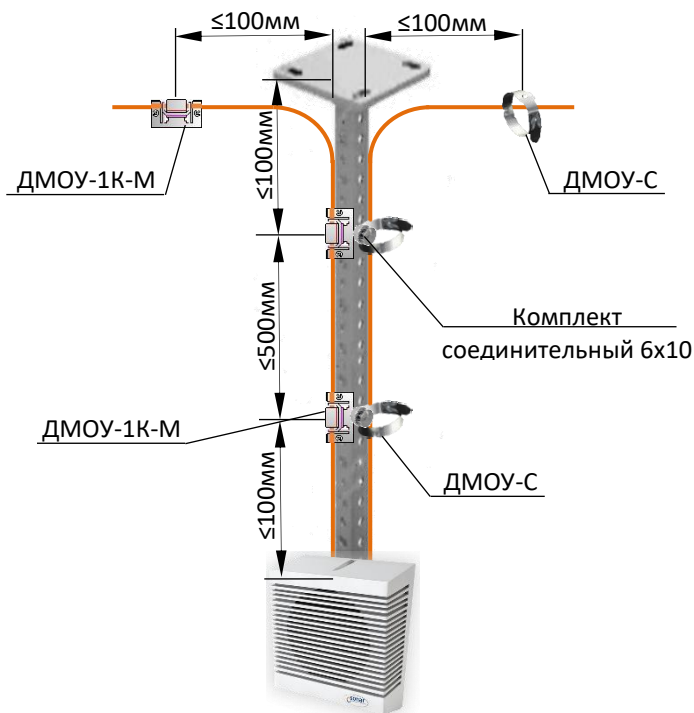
Спуск кабеля по стойке консольной сварной при открытой прокладке
